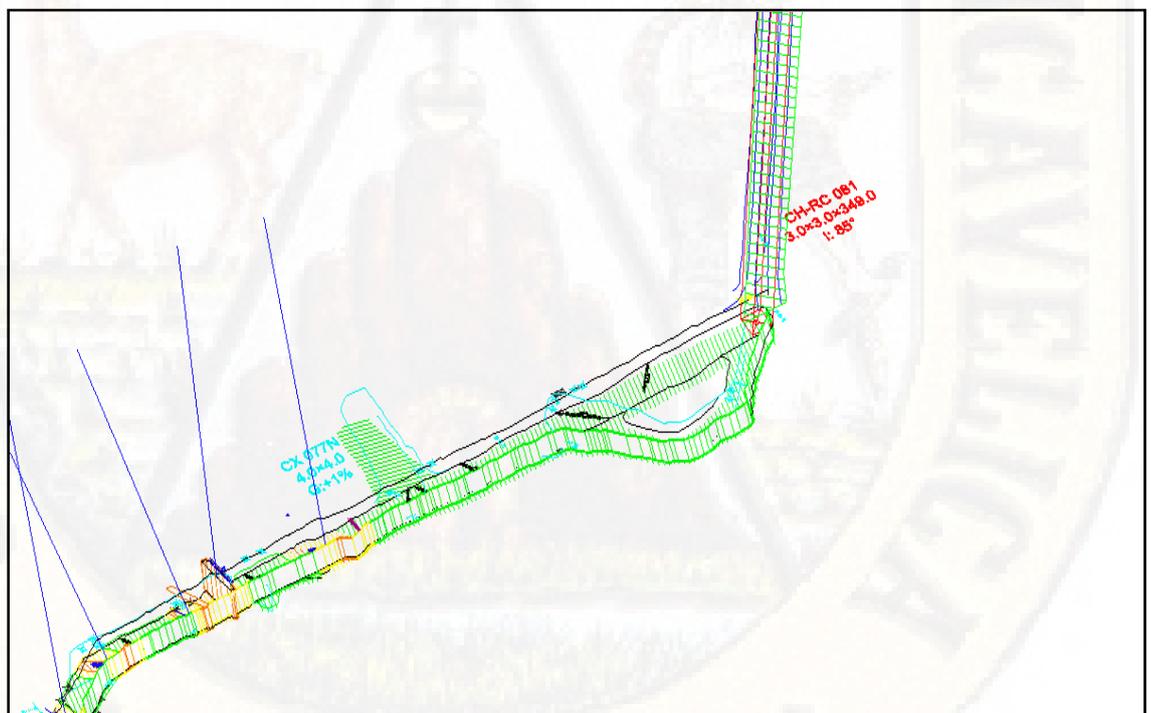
Zonamiento geomecánico-estructural de la CX 077N y la CHRC 077N
